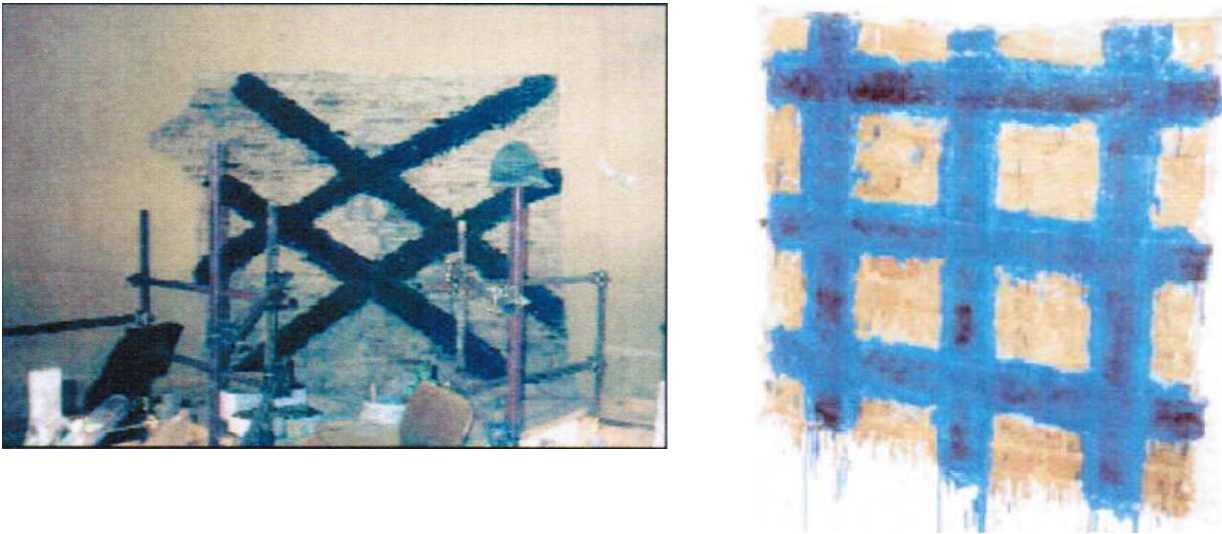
Rinforzo di pareti murarie con strisce di laminati in FRP
